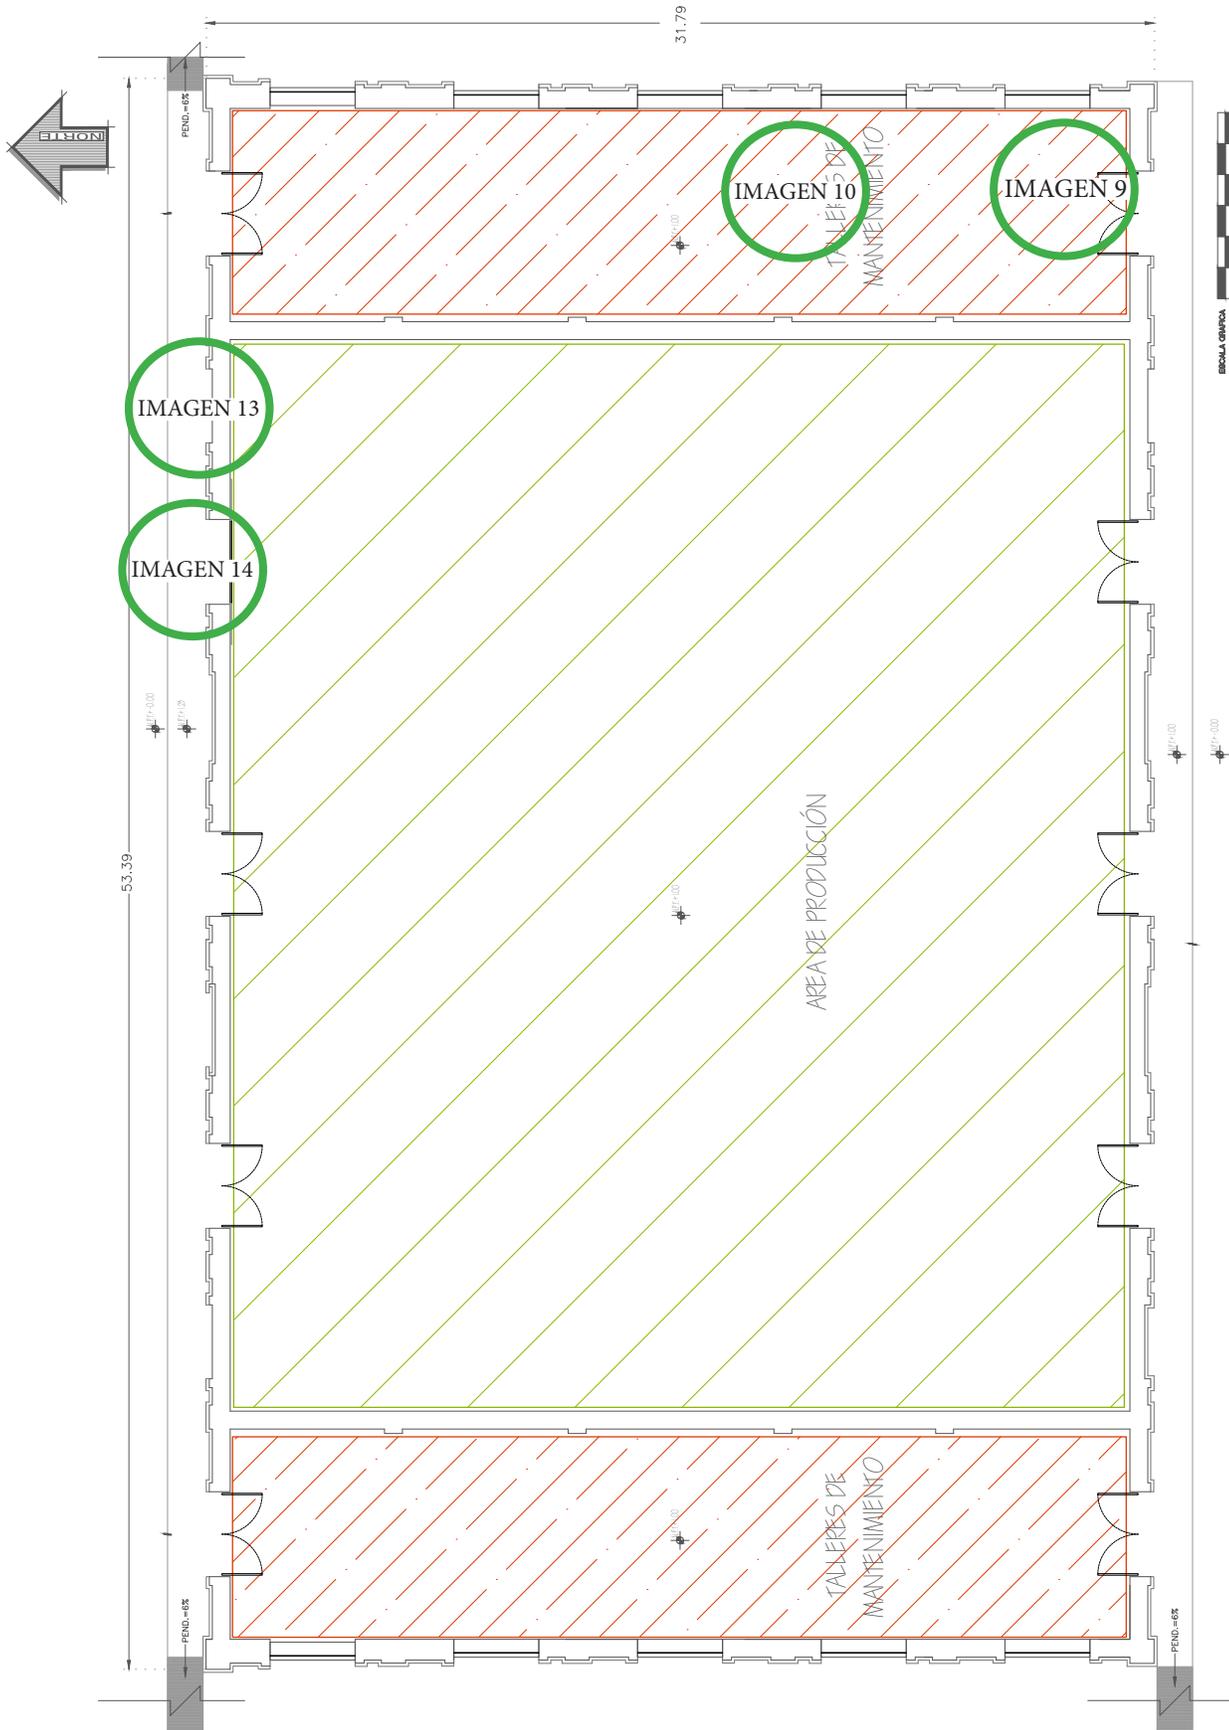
Planta arquitectónica edificio-C poniente con la ubicación de las imágenes que corresponden a la zona de taller de mantenimiento y al encuentro de Álvaro Obregón y Venustiano Carranza
